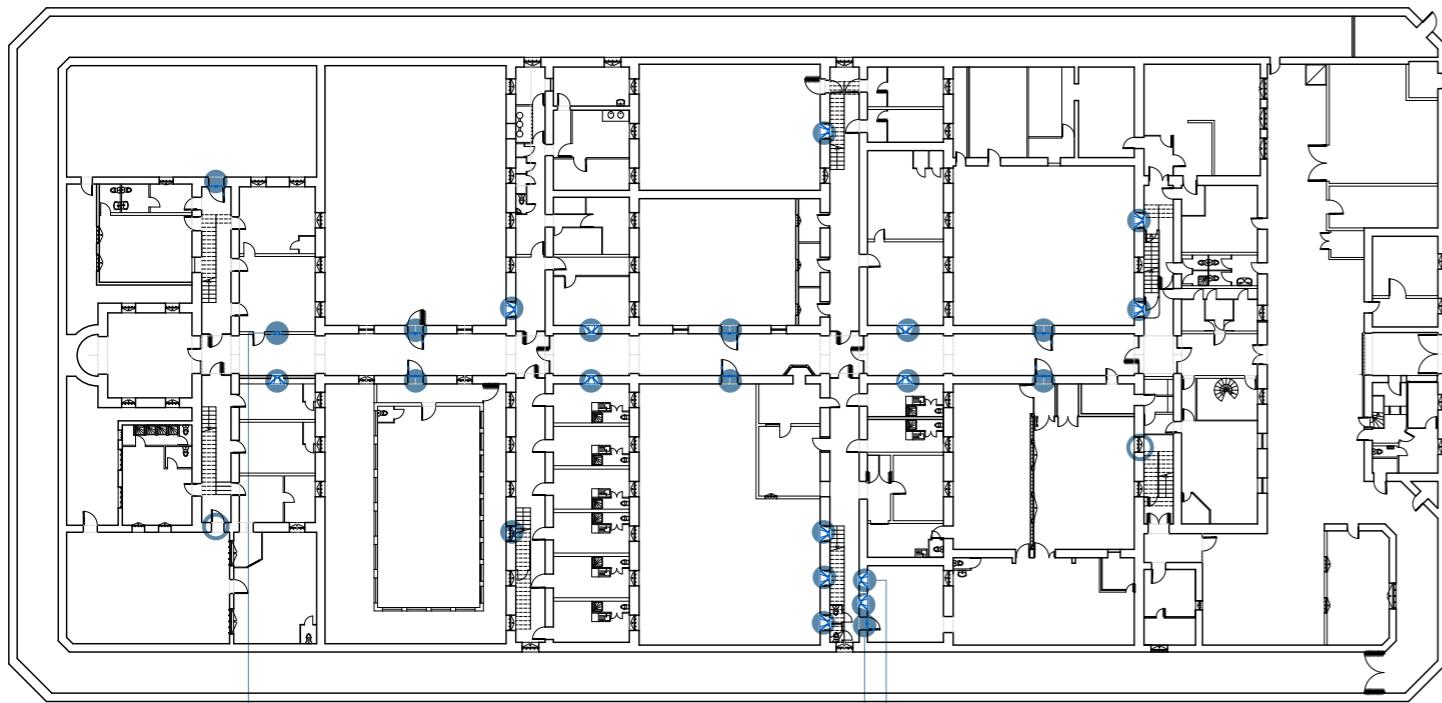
Plan de Rdc : repérage des judas. Source : Croisée d'archi.
